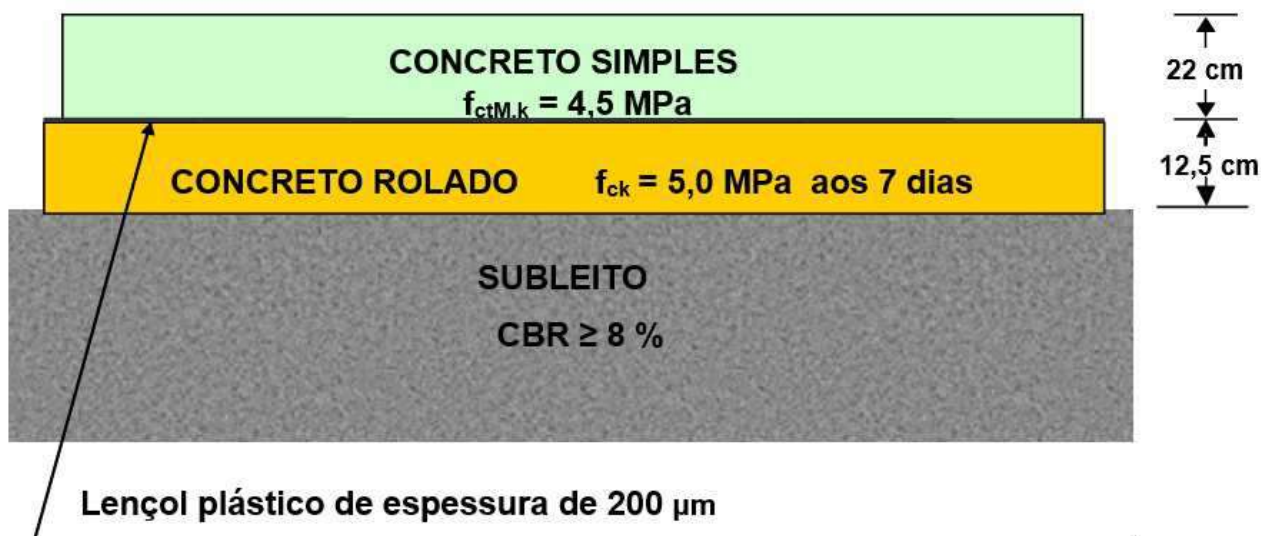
Estrutura de pavimento rígido da Av. Hélio Prates.
